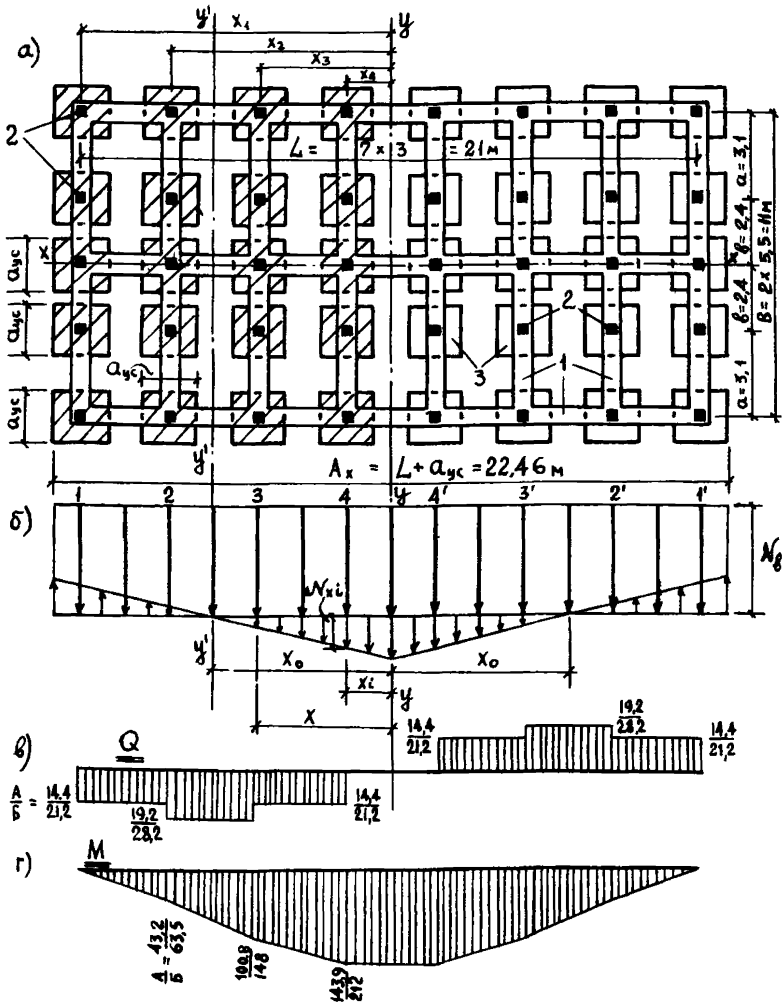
К расчёту свайного фундамента на искривленном основании (+R_н):
